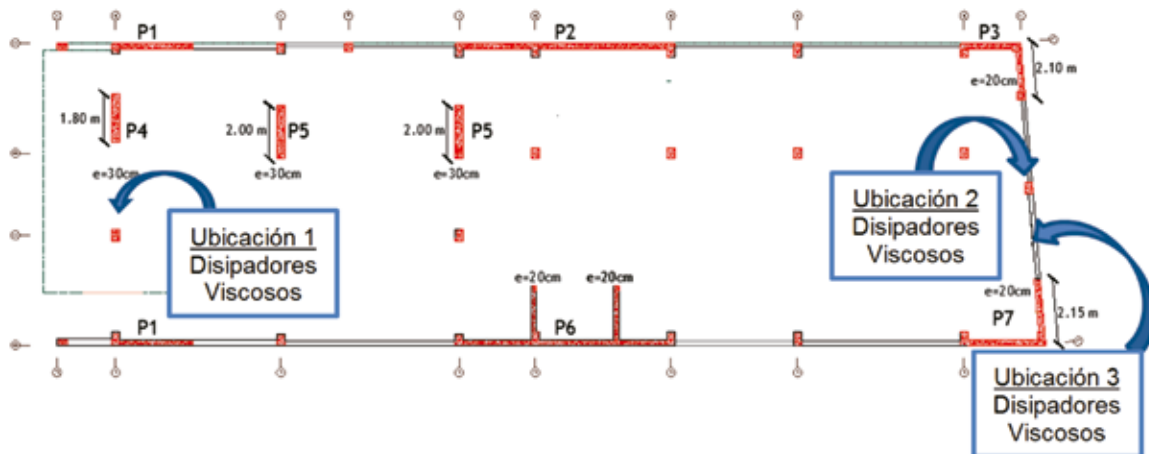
VISTA EN PLANTA – ELEMENTOS DE CORTE (1ER - 5TO NIVEL)
